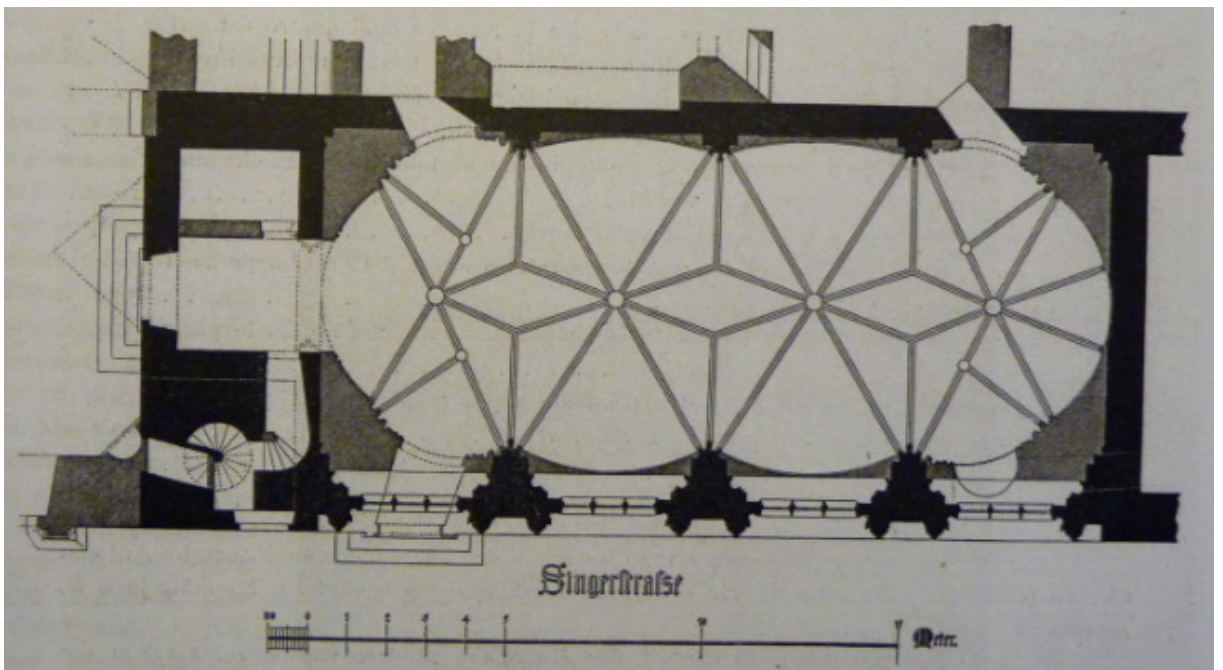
, Deutschordenskirche, Wien, Grundriss, ab 1720.
